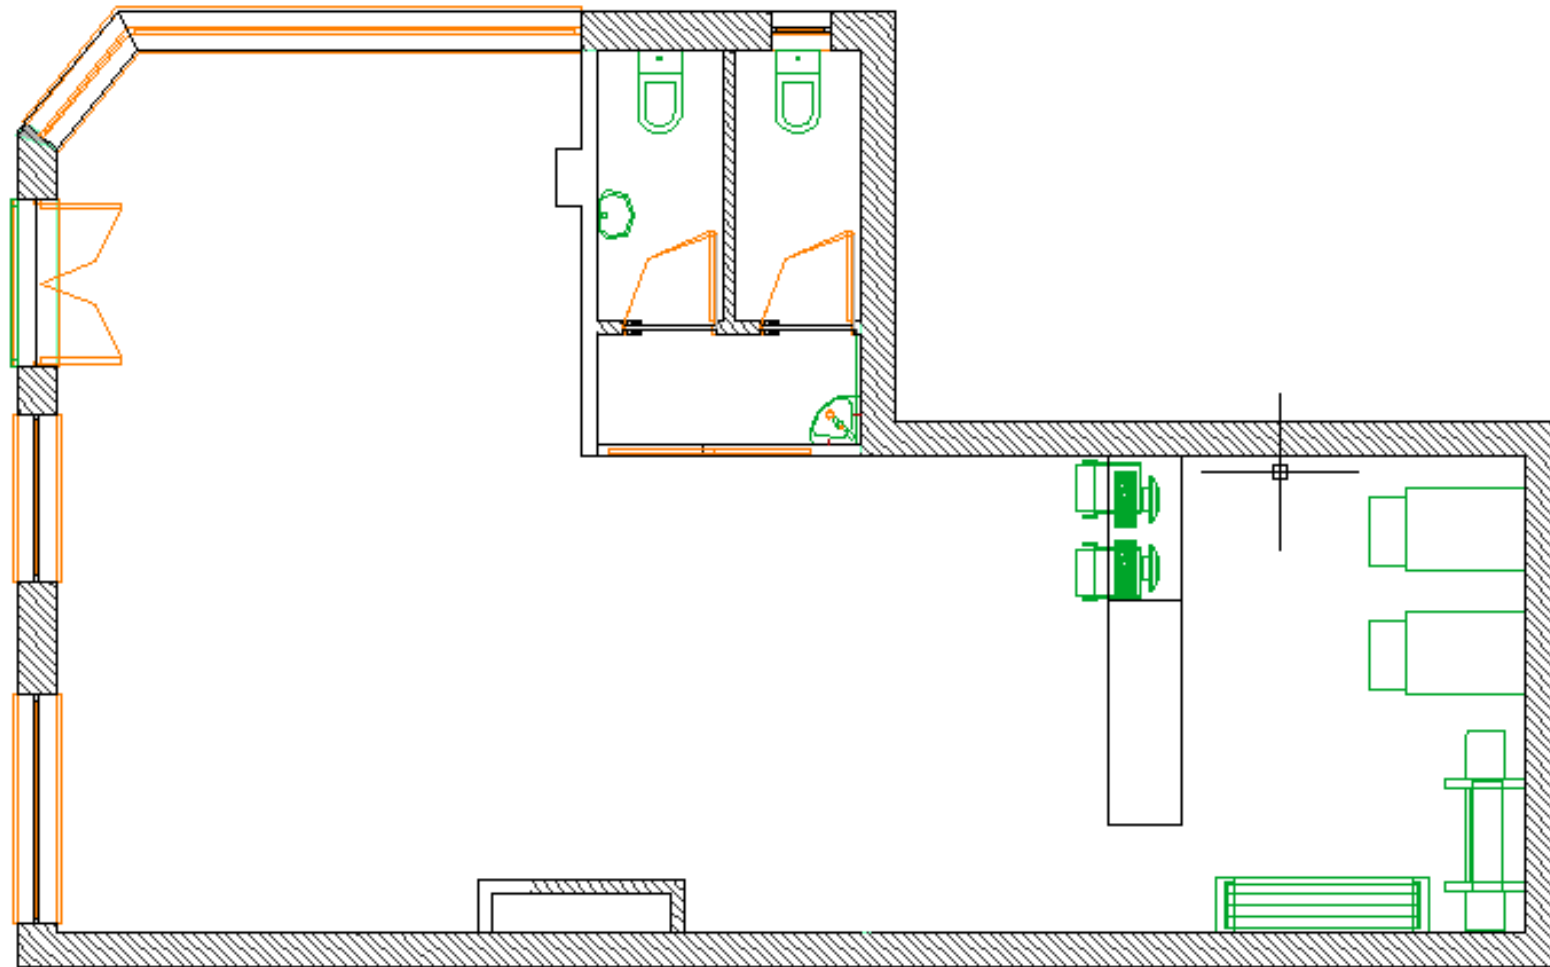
Adaptado da Planta do Bar (Ponto de Vista A)
